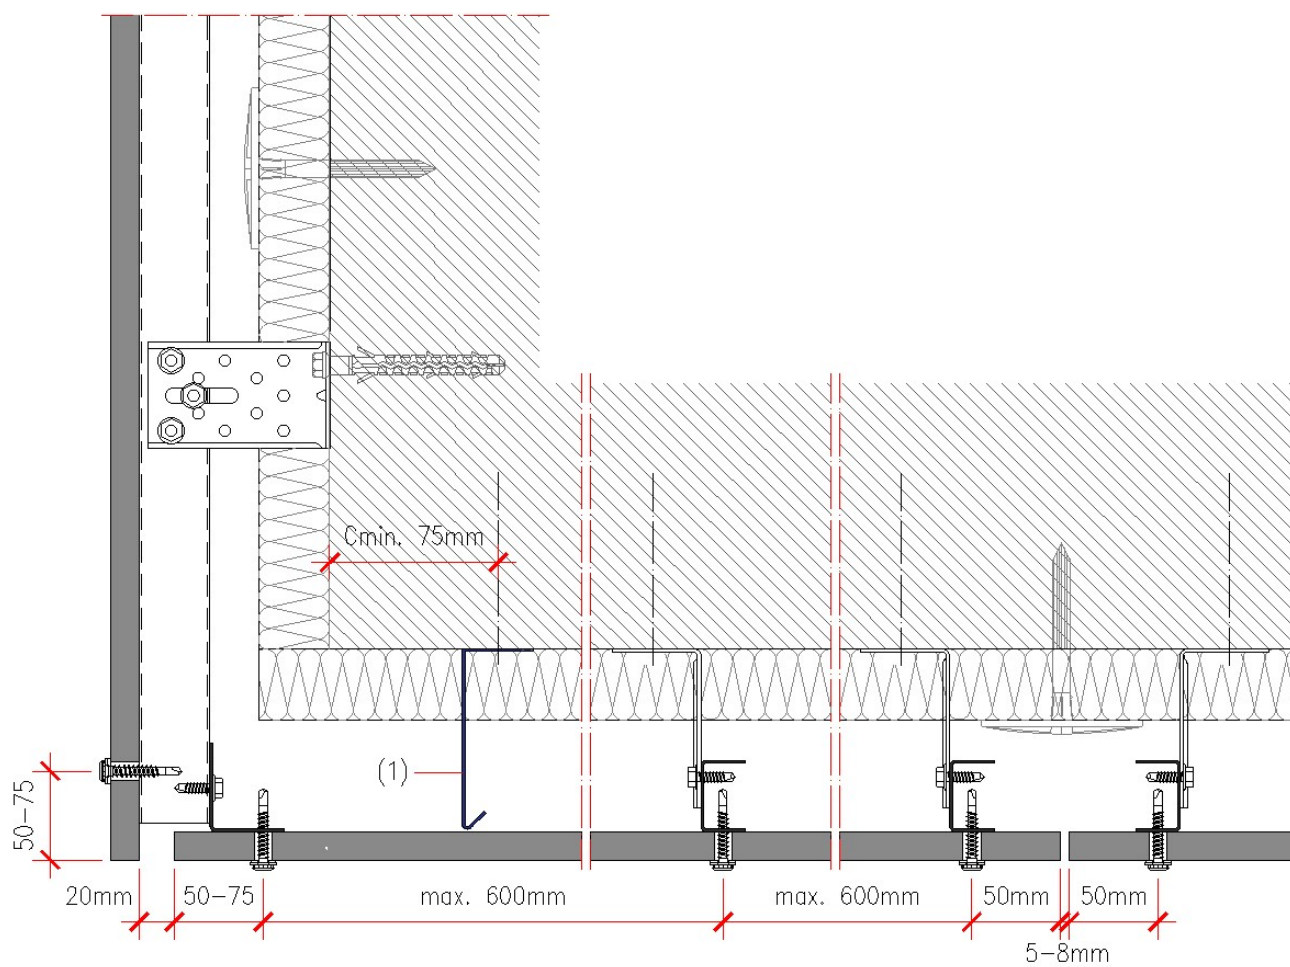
Pormenor da ligação Fachada - Teto falso
